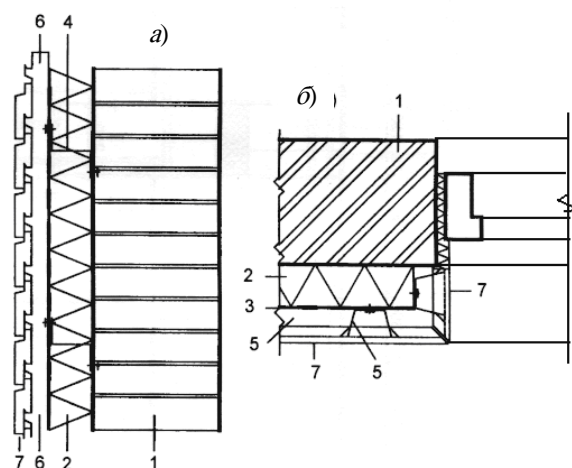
Кирпичная вентилируемая стена с навесной фасадной облицовкой:
